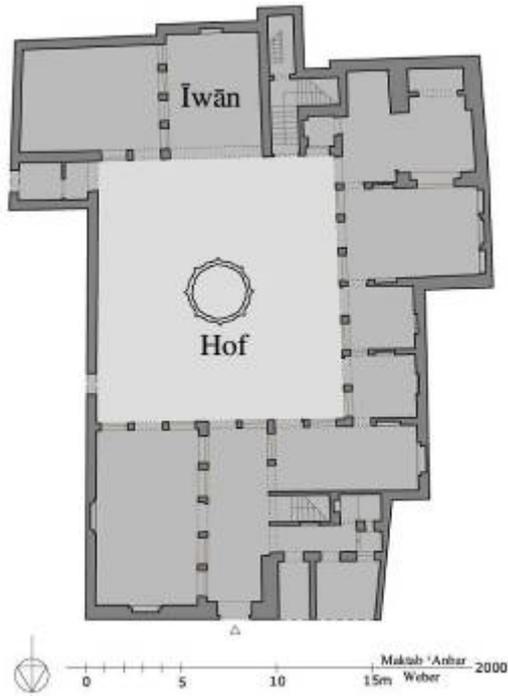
Bayt Mardam Bek, Grundriss EG
